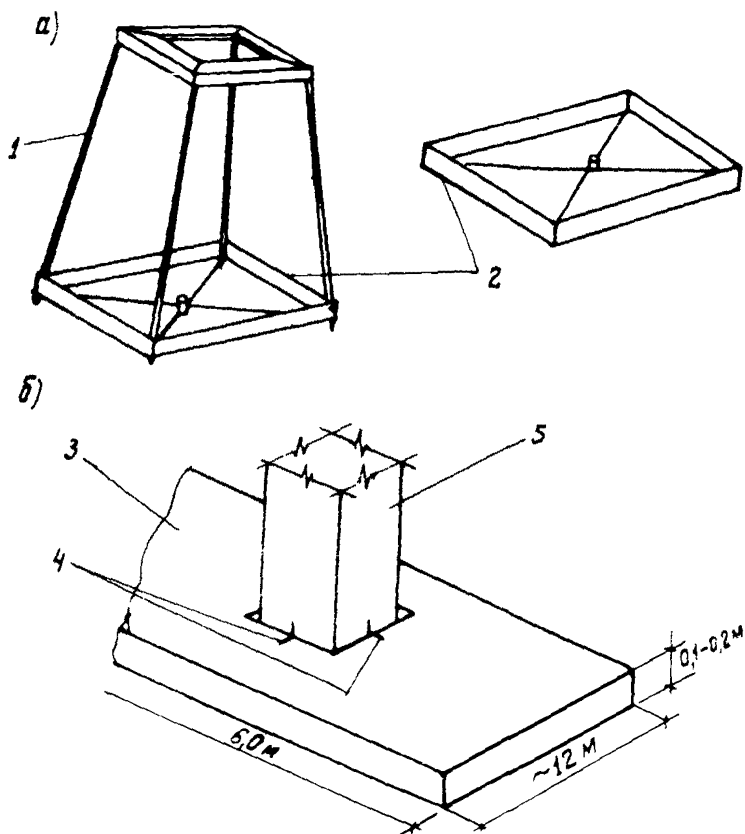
Кондукторы для обеспечения точности установки свай перед забивкой:
